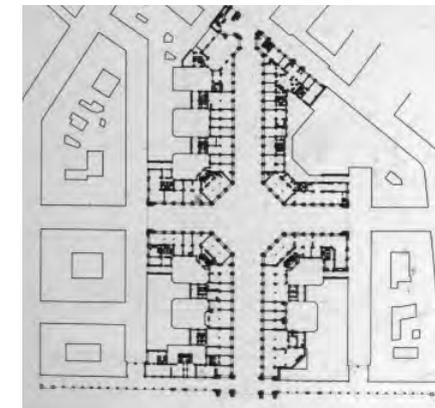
Galleria Vittorio Emanuele II, Grundriss
